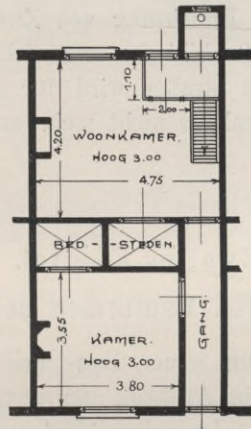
Kleinhaus. Reihenbau; Baustellenbreite 5 m; Bauzeit 1880—1890. Unternehmerbau. Arnheim.
